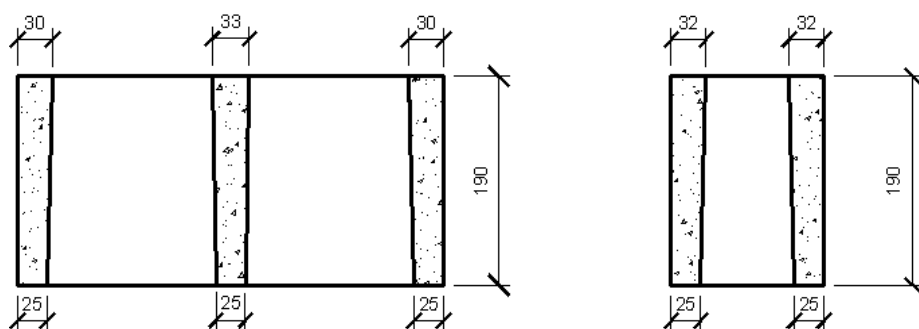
Corte transversal do bloco de concreto (medidas em mm)
